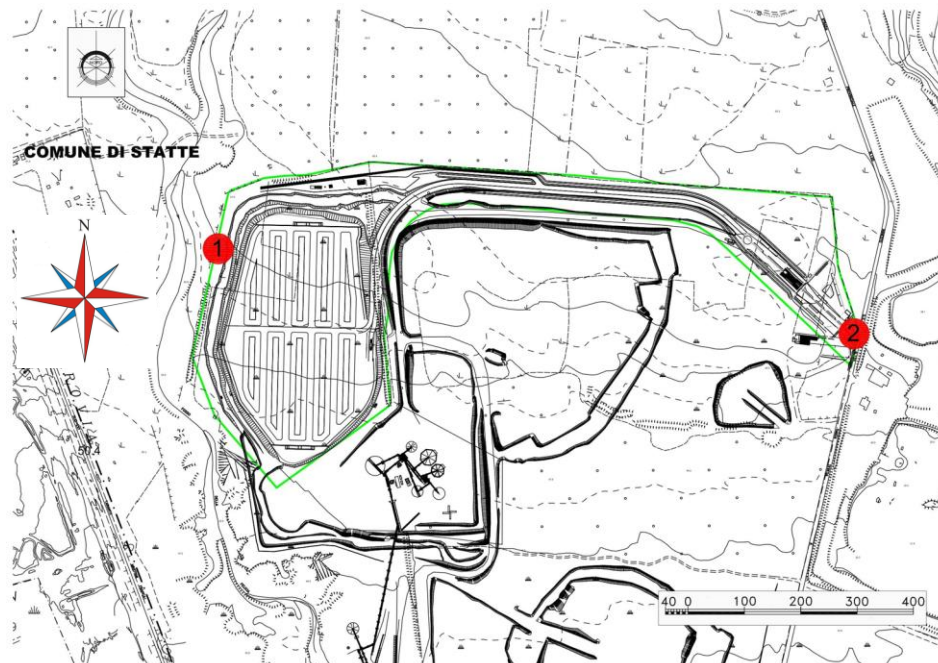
Planimetria dell'area con ubicazione dei punti di campionamento del rumore
